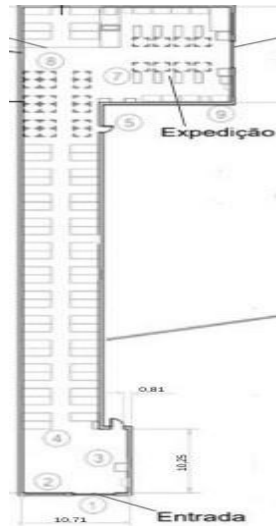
Planta baixa do layout atual (prateleiras em 3 longas filas paralelas)
